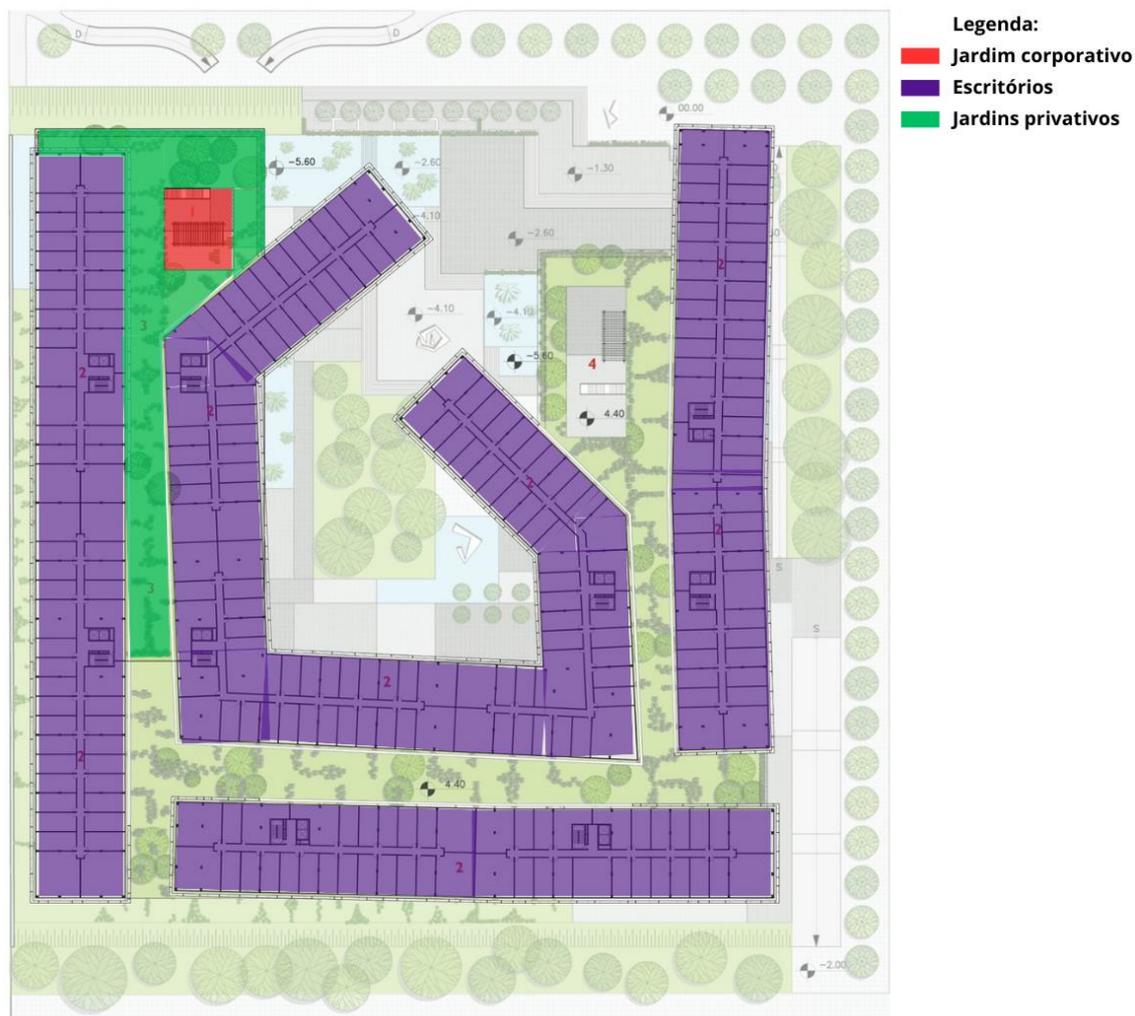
Planta baixa térreo do Complexo Multiuso SIA
